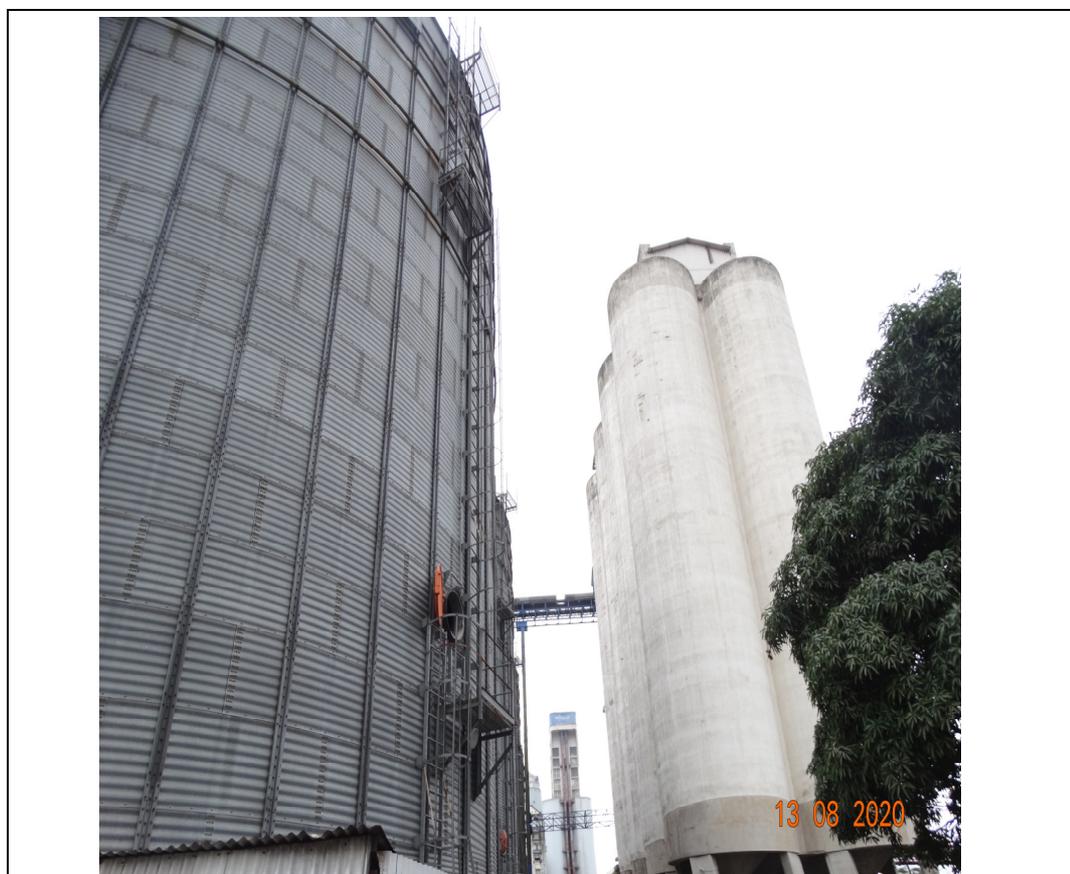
OUTRA VISTA ENTRE OS SILOS METÁLICOS E SILOS DE CONCRETO ARMADO.
